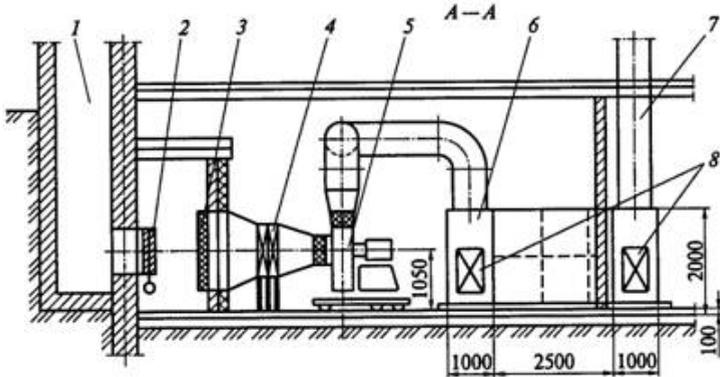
Приточный центр: 1 – воздухозаборная шахта; 2 – воздушный клапан; 3 – фильтр; 4 – воздушонагреватель; 5 – вентилятор; 6– шумоглушитель; 7 – приточный воздуховод; 8 – люки обслуживания.
